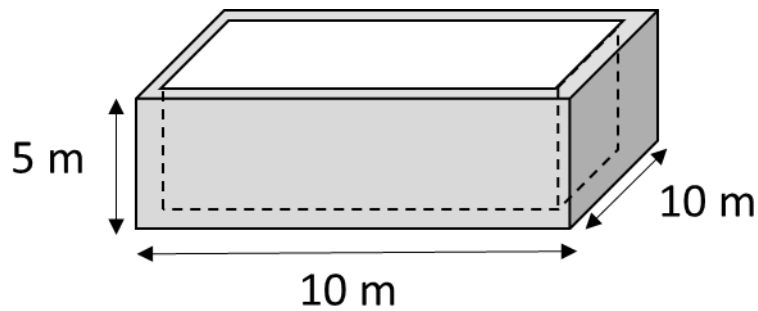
Plano tanque de almacenamiento (Fuente: Elaboración propia)
